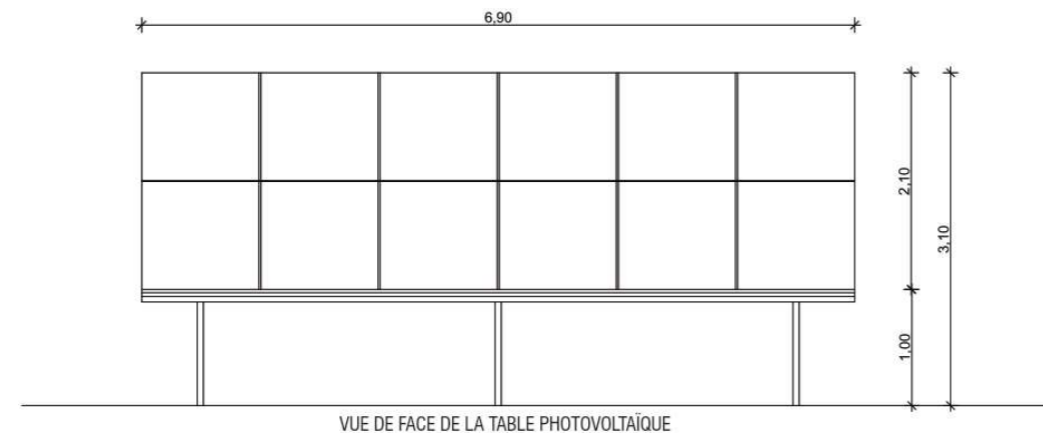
Vue de face d'une grande table photovoltaïque (12 panneaux) sur pieux battus
